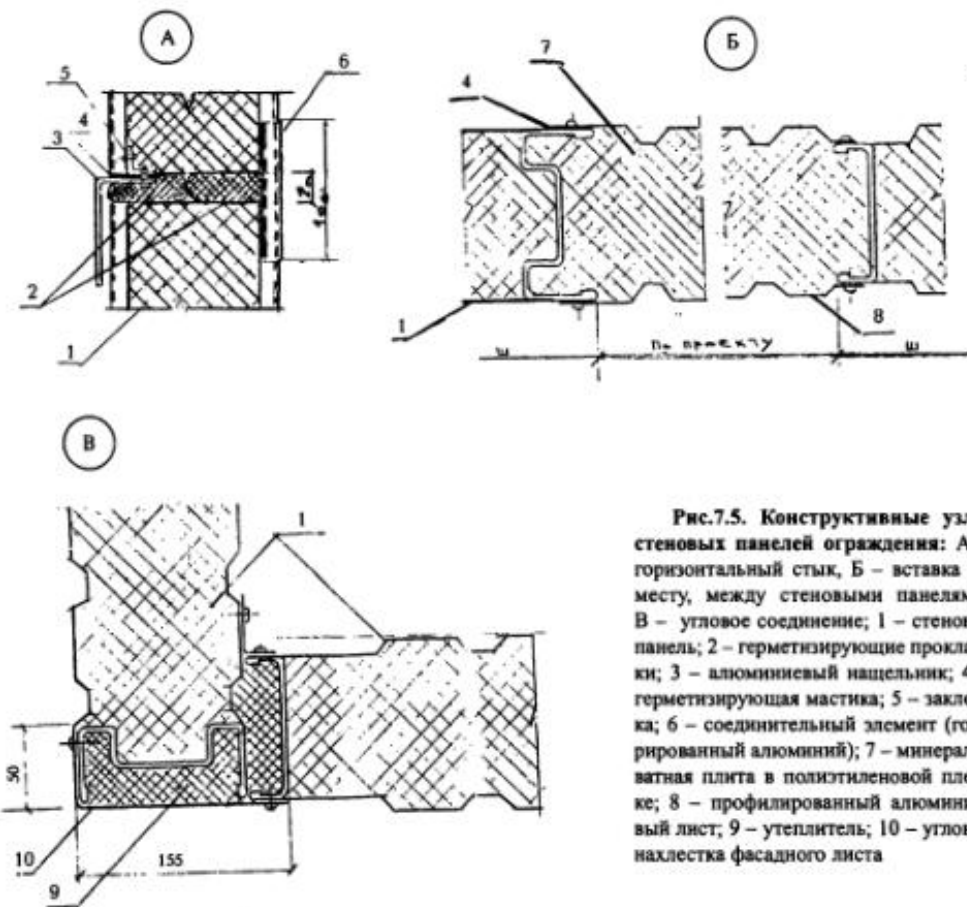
Конструктивные узлы стеновых панелей ограждения: А – горизонтальный стык, Б – вставка по месту, между стеновыми панелями, В – угловое соединение; 1 – стеновая панель; 2 – герметизирующие прокладки; 3 – алюминиевый нащельник; 4 – герметизирующая мастика; 5 – заклепка; 6 – соединительный элемент (гофрированный алюминий); 7 – минераловатная плита в полистиленовой пленке; 8 – профилированный алюминиевый лист; 9 – утеплитель; 10 – угловая нахлестка фасадного листа
